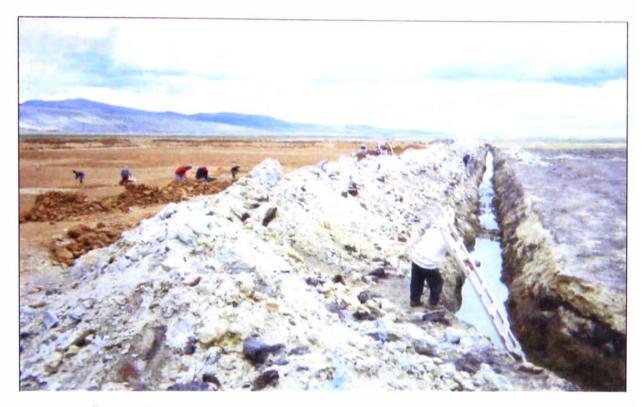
Canal de Drenaje Mayor en el lado derecho de la laguna, eon cola de fondo por debajo del fondo de la laguna, a fin de cortar el nivel freálico ollo.
